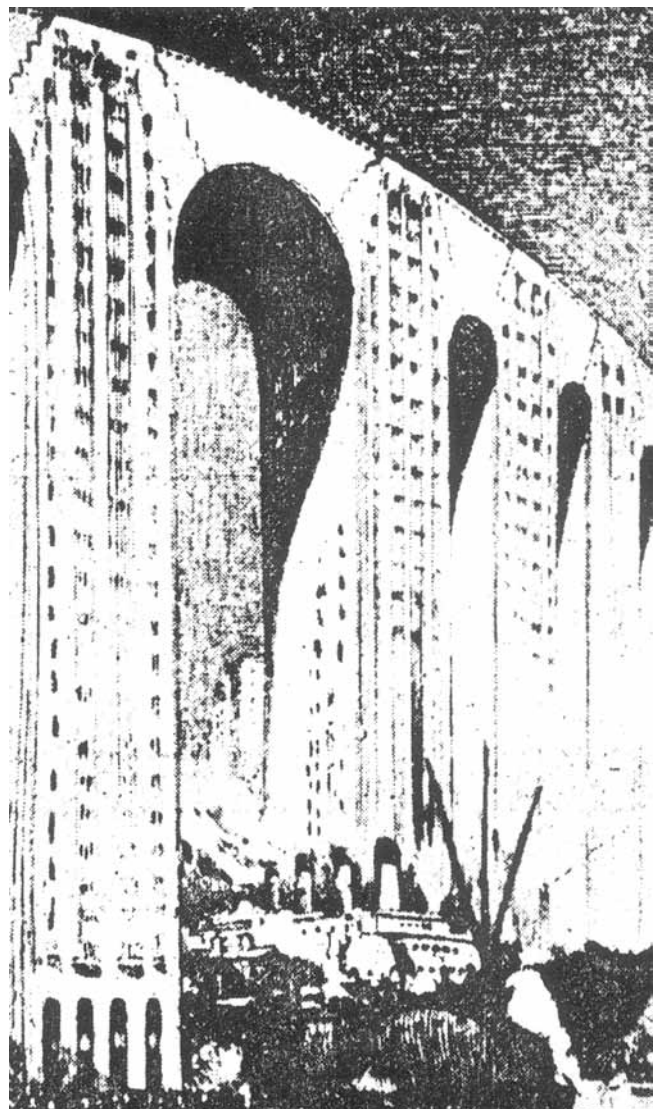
Ontwerpvoorstel van Hood voor hangbrug in New York.
